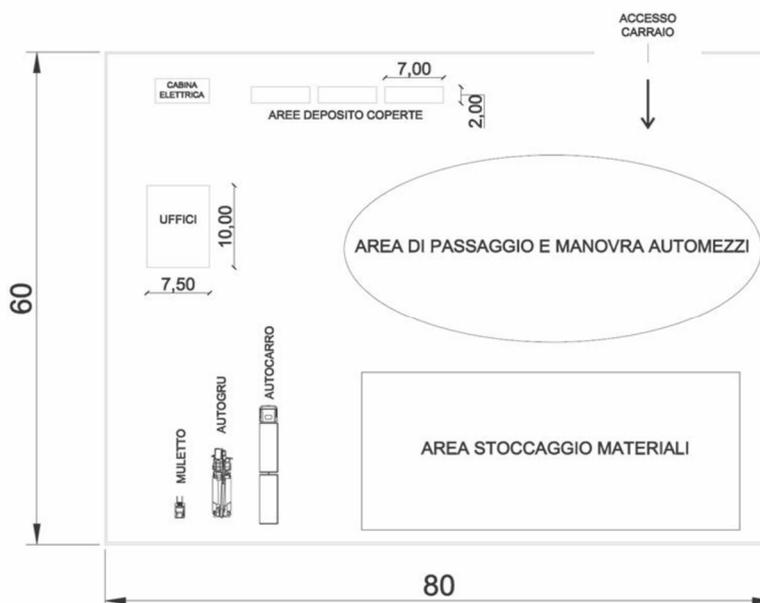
Planimetria dell'area centrale di cantiere - misure indicative
